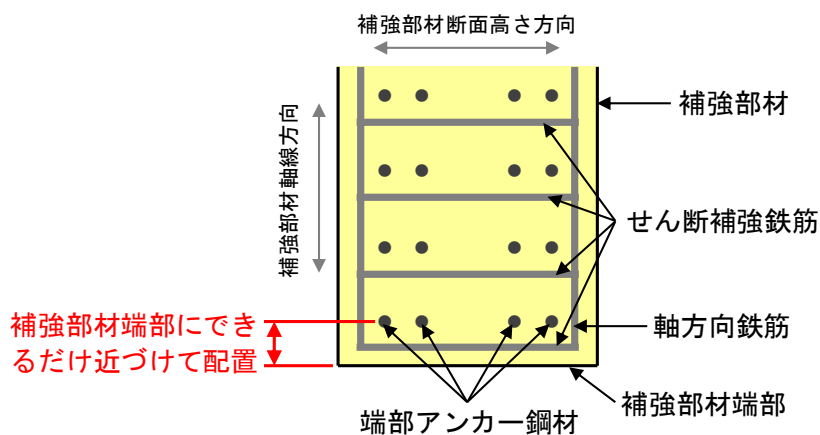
補強部材端部付近のアンカー鋼材配置 (補強部材正面図)
